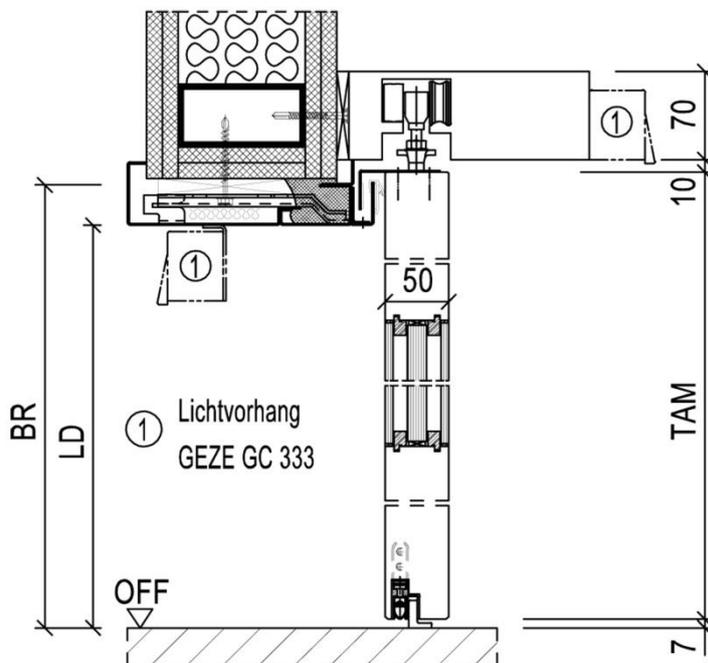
Zwei-schalige Stahlzarge zur Abdichtung mit Fugenfüller für den Einbau der Brandschutz-Schiebetüren in Leichtbauwände.
